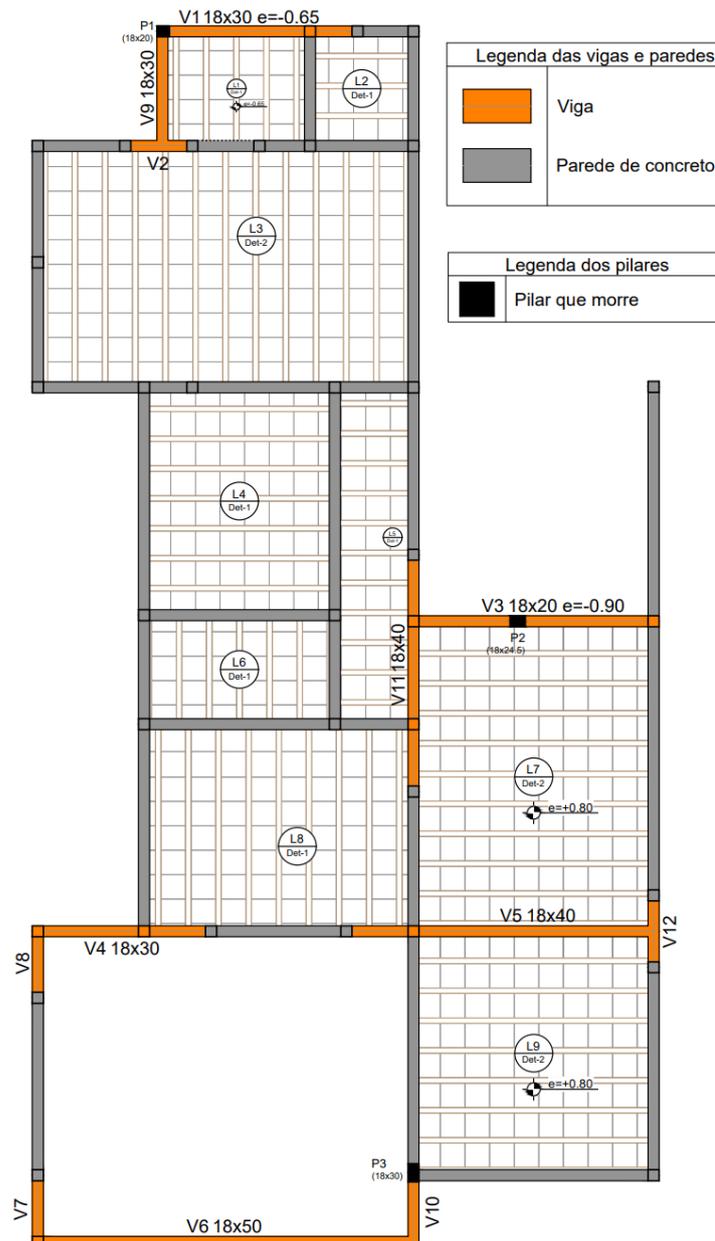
Projeto Estrutural (Fonte: ICF Construtora, 2023).
